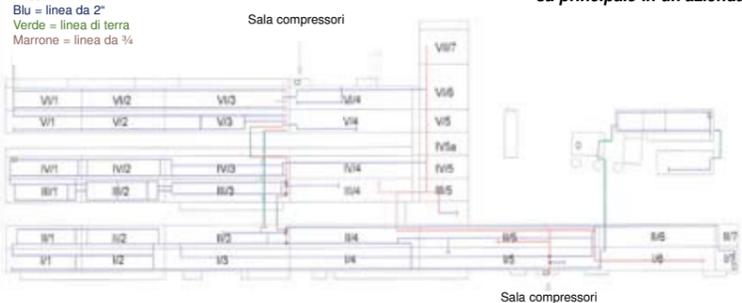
Planimetria (pianta) della linea d'aria compressa principale in un'azienda
